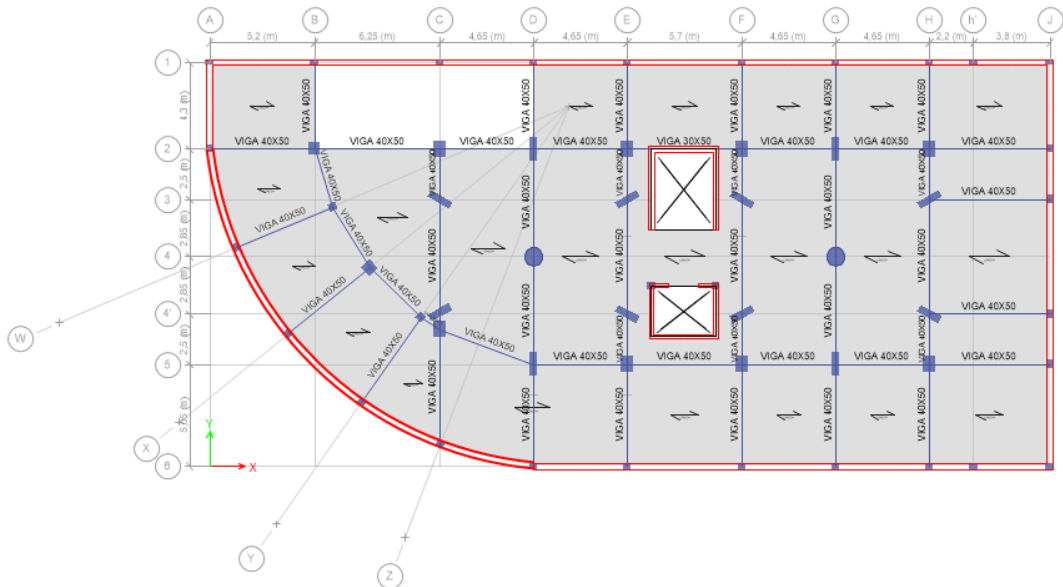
Planta nivel -2.88 m Edificio Silva Núñez
